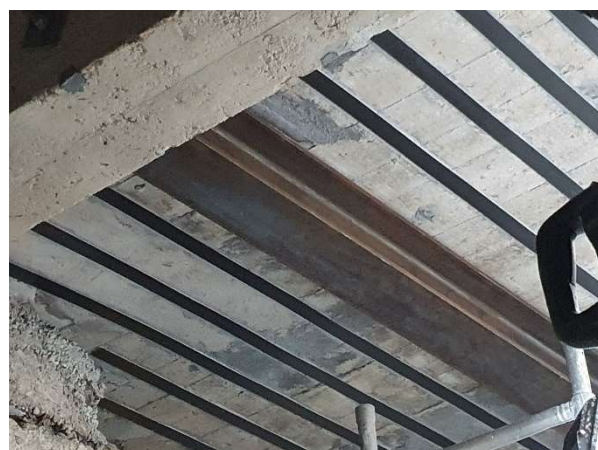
Refuerzo de losa con láminas de fibras de carbono (FRP) y nuevo perfil metálico de apoyo.
